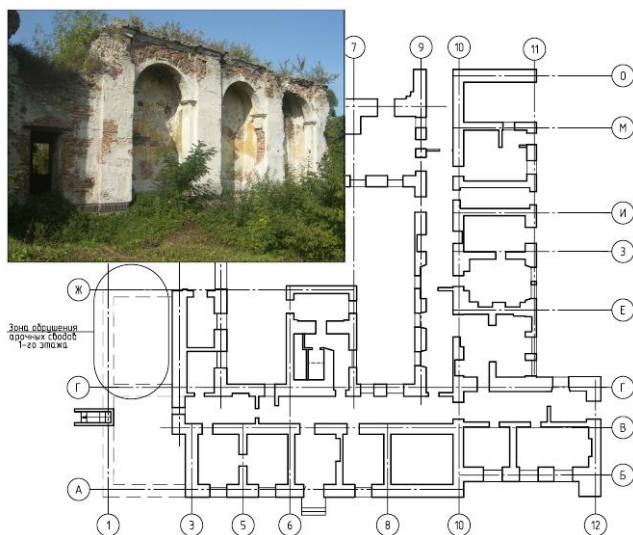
План 1-го этажа (фасад в осях 9-1/H)
